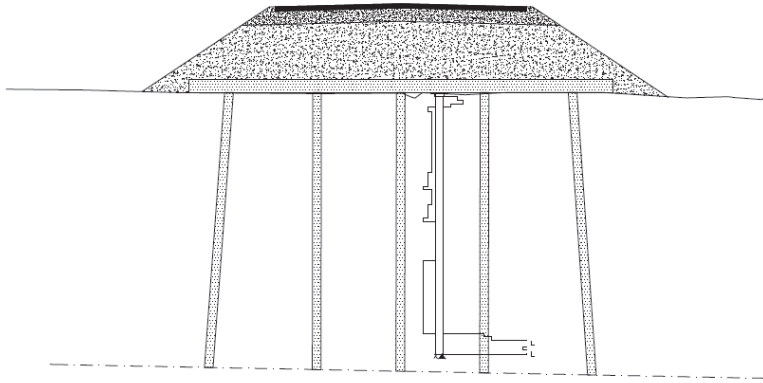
Pilaristabilointia Kerava-Lahti oikoradan työmaalla (Kansonen, 2005)
